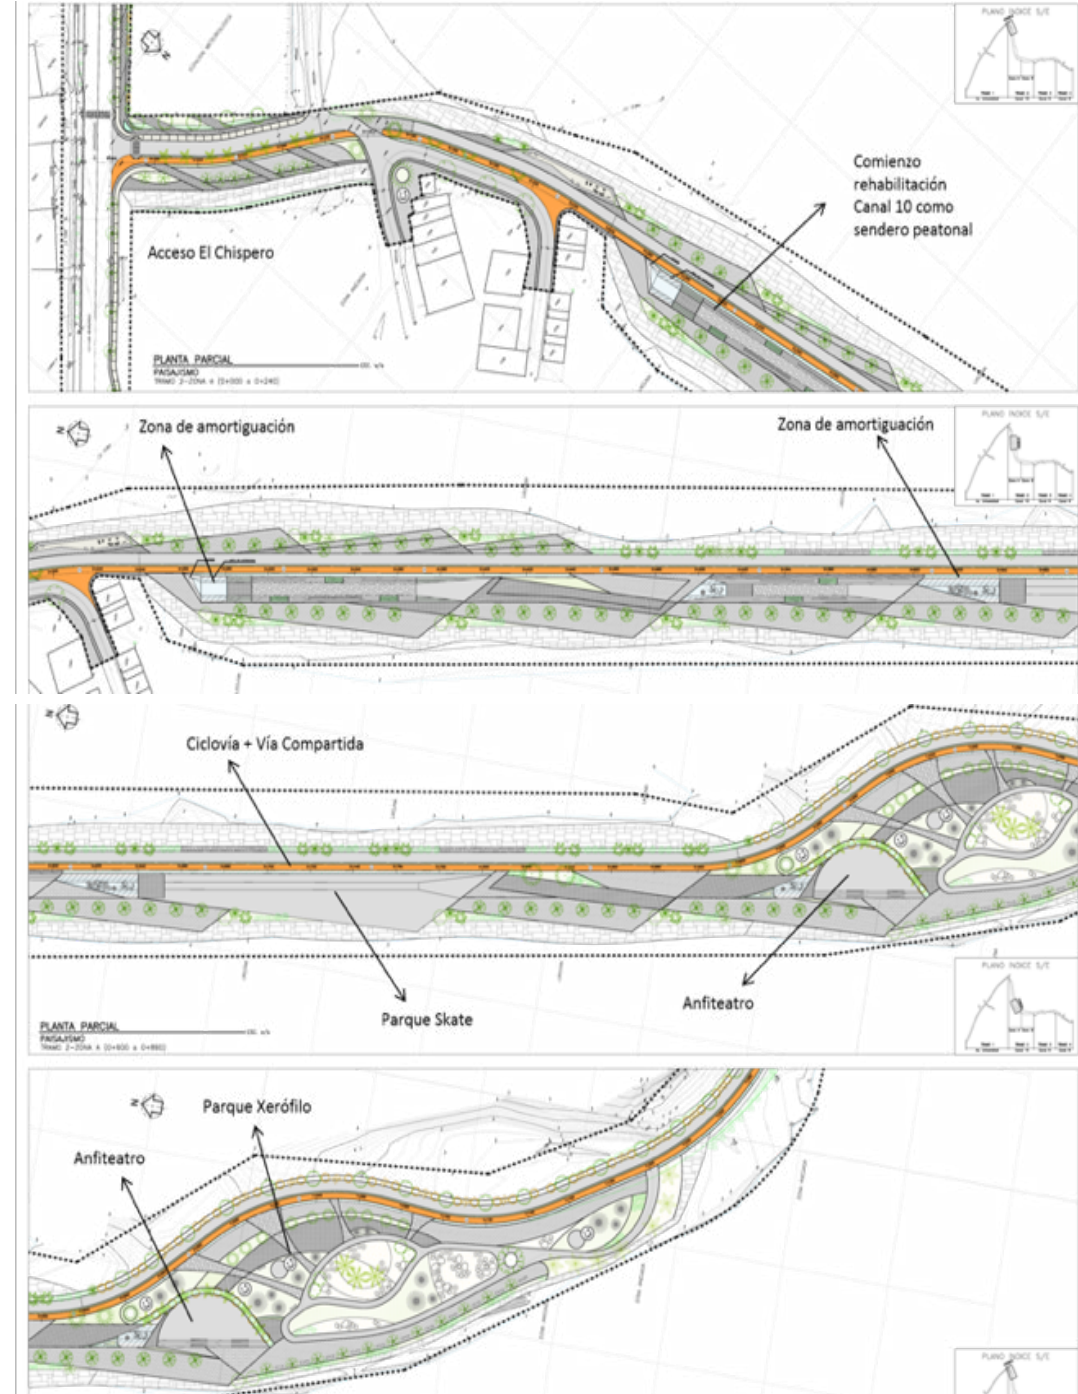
Planta y sección tipo de las actuaciones en el canal 10 - UDO
